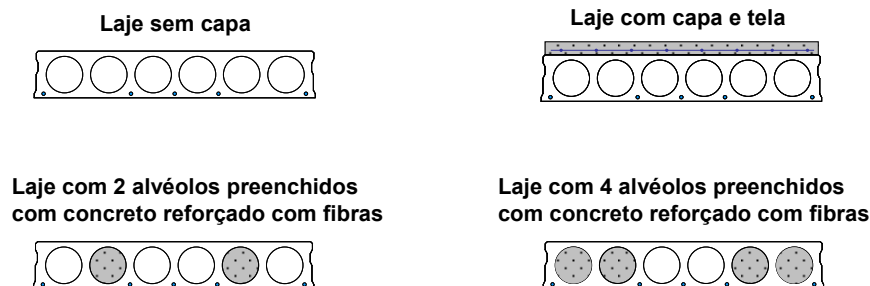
Tipologias de lajes alveolares ensaiadas.
